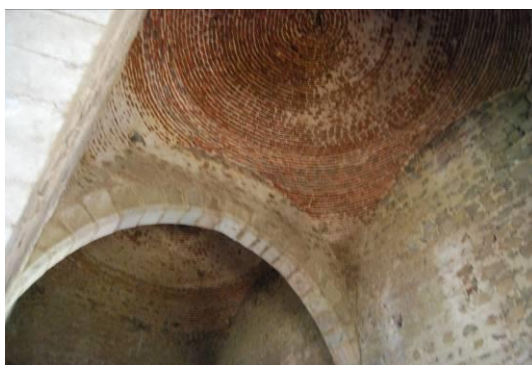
Cubrición de la planta baja de la torre del homenaje del castillo de Burguillos, foto del autor
